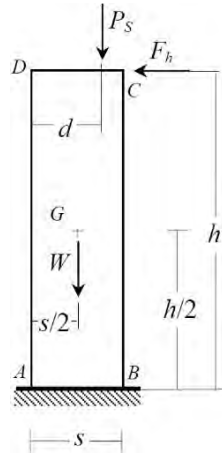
Geometría y cargas aplicadas en un muro simple (Beolchini, 2007)
